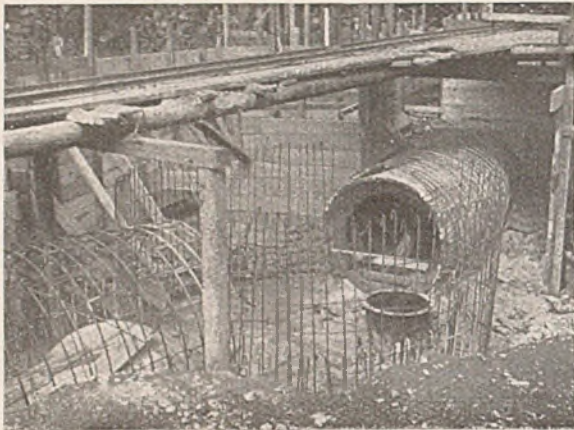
Armierte Rohranschlüsse an den Druckausgleichturm.
